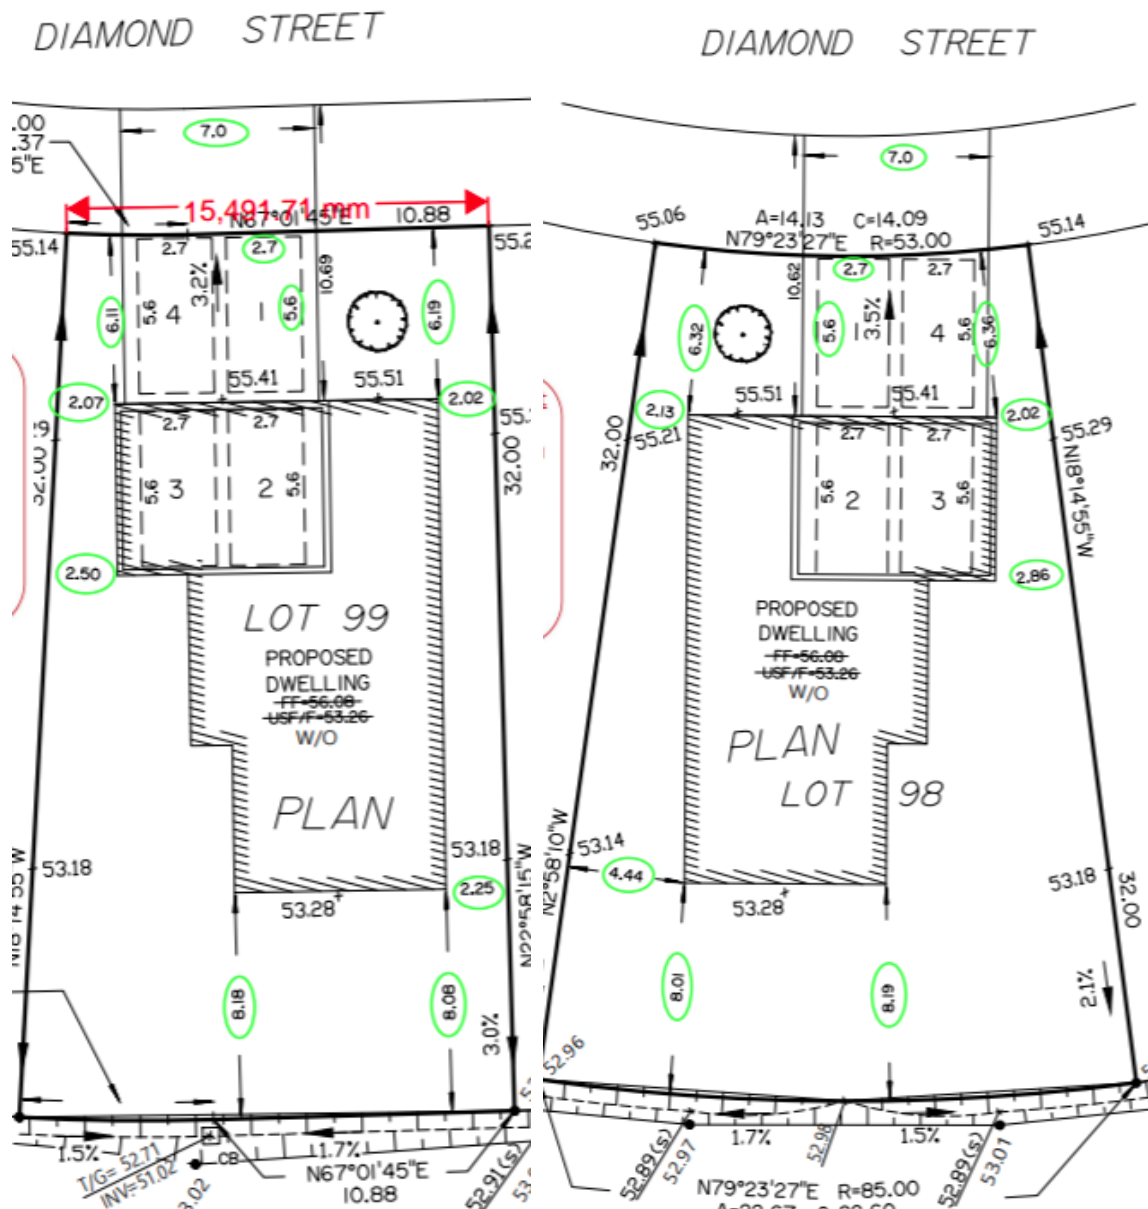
Illustration de la configuration des quatre cases en tandem sur le plan d'implantation du dossier de permis de construction pour chaque lot.
